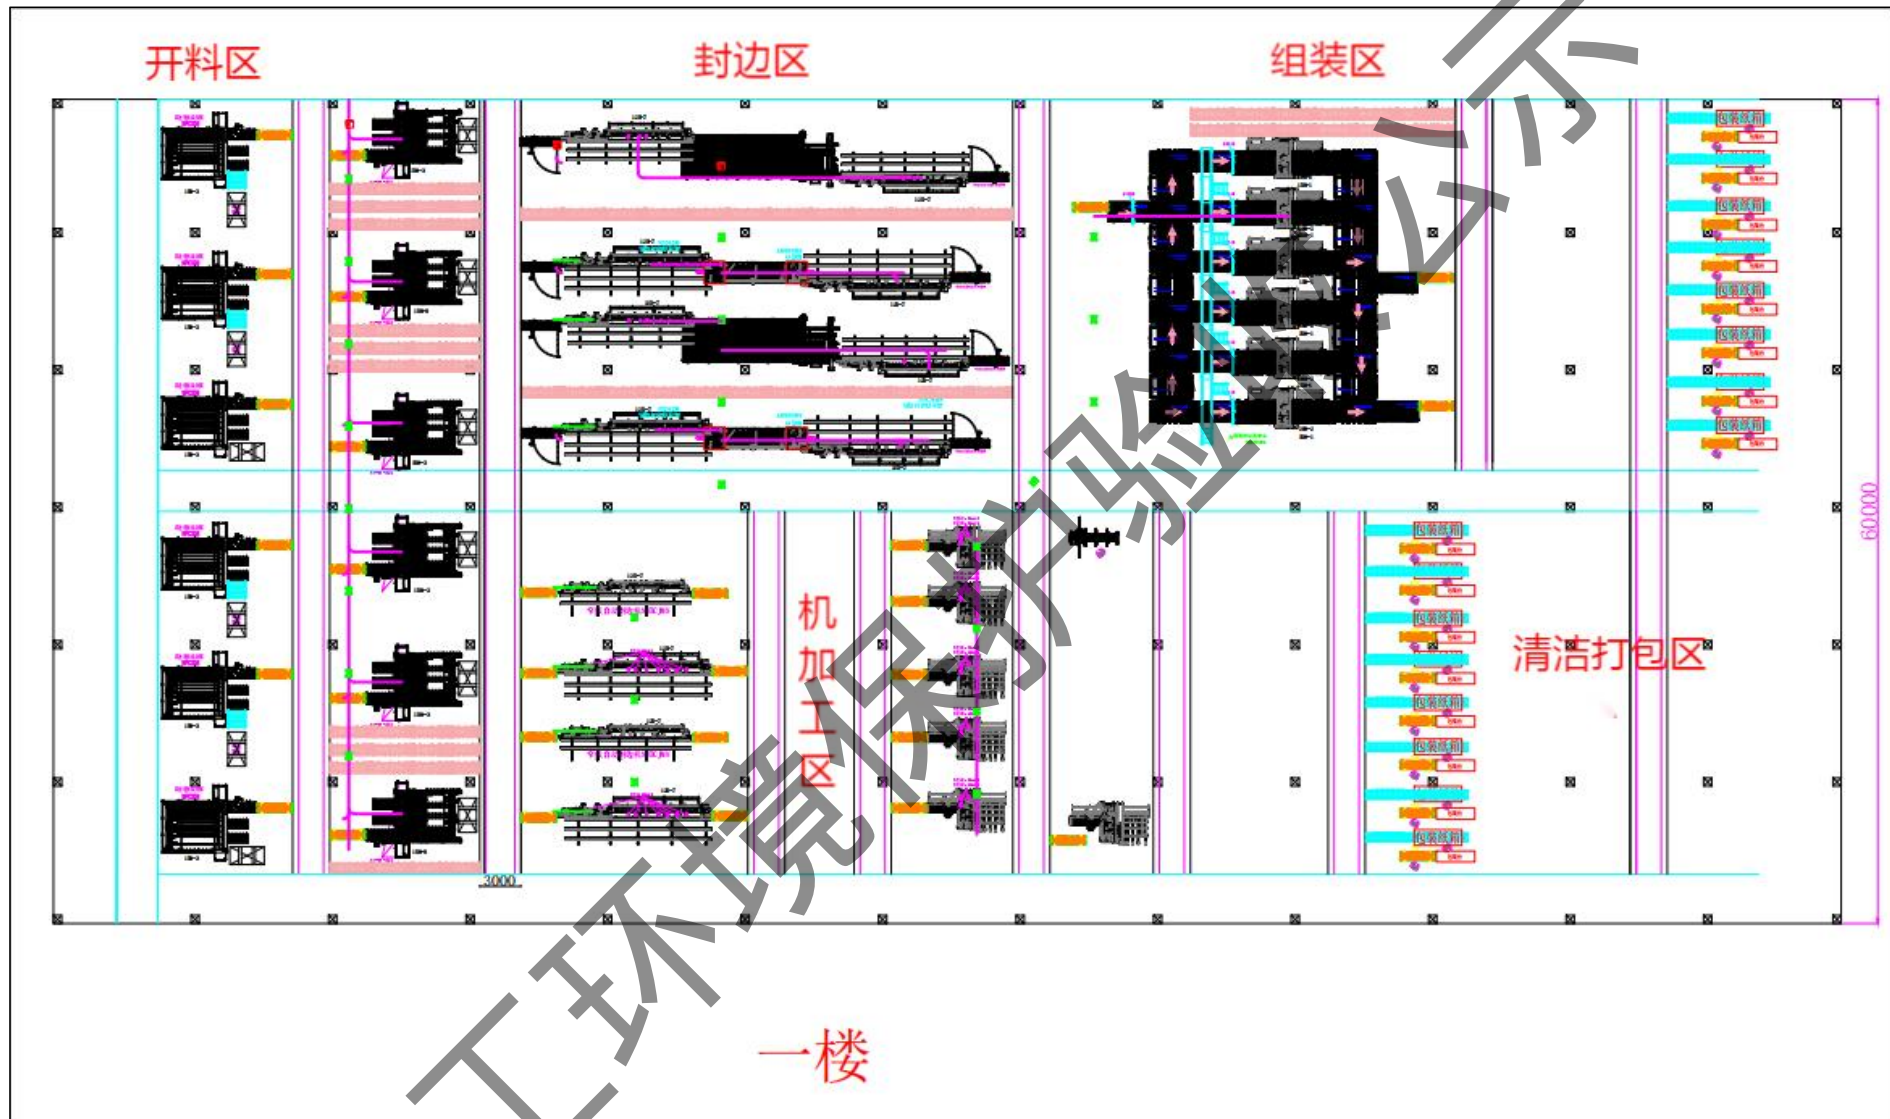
(2) 平面布置图 (生产厂房首层平面图)
